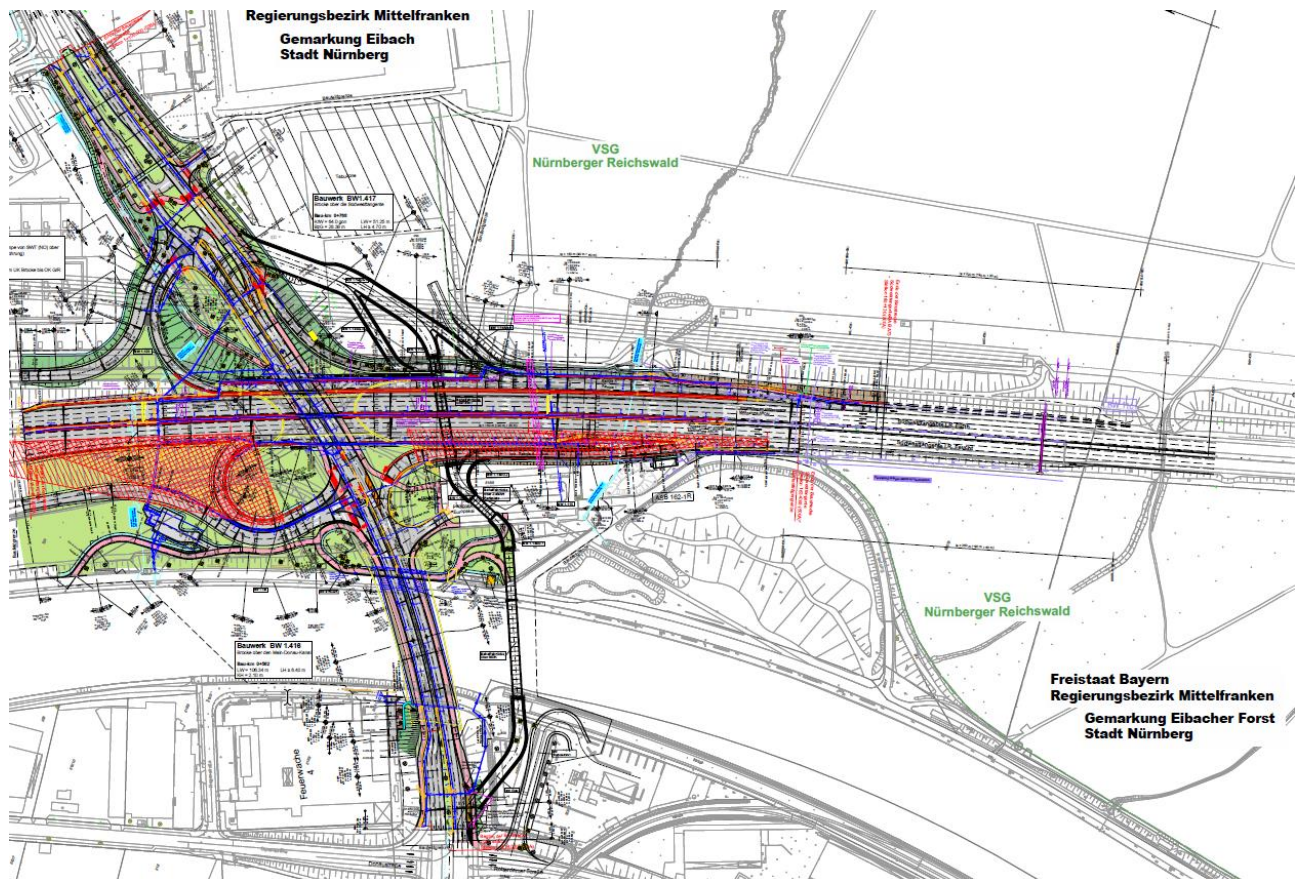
Lageplan 200 Verkehrsanlage Hafenstraße - Entwurf
